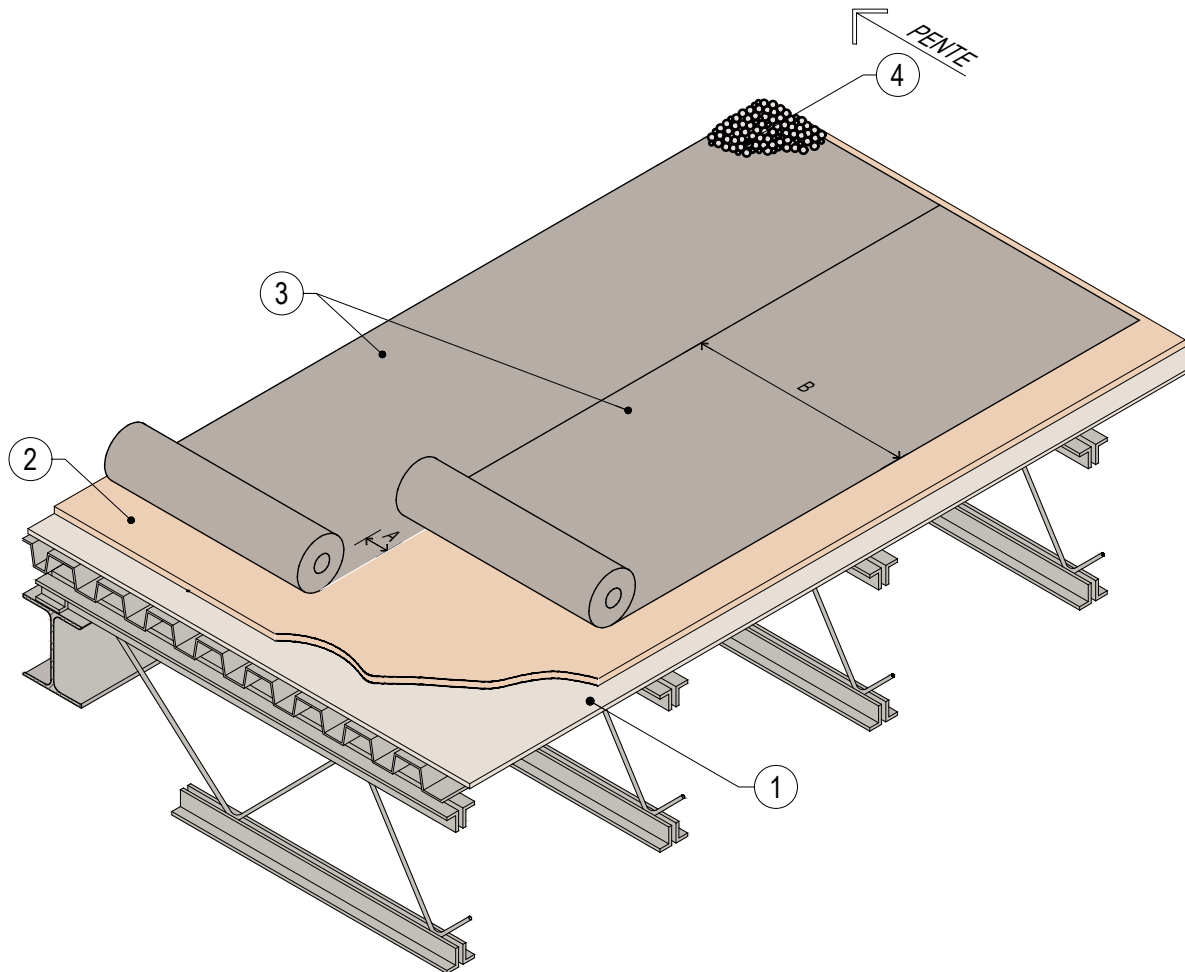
PLATELAGE D'ACIER DES TESTS D'ARRACHEMENT AU VENT
